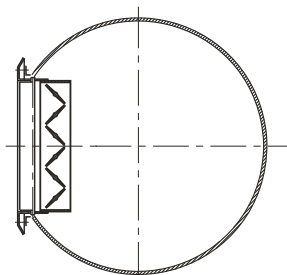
Схема установки решеток вентиляционных типа РШ-1, РШ-2, РШ-4 в воздуховоде.
